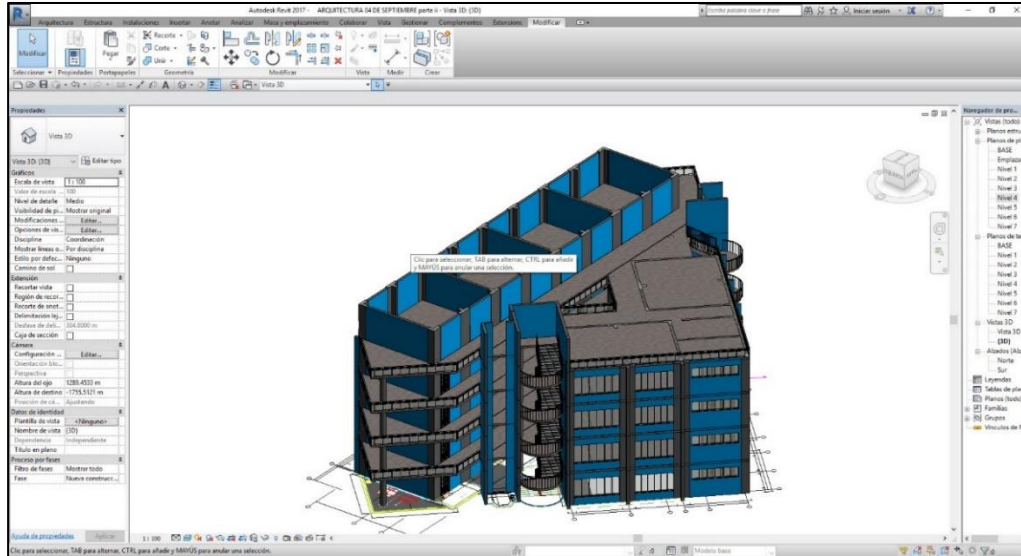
Modelado de muros y columnas en la azotea del edificio.
